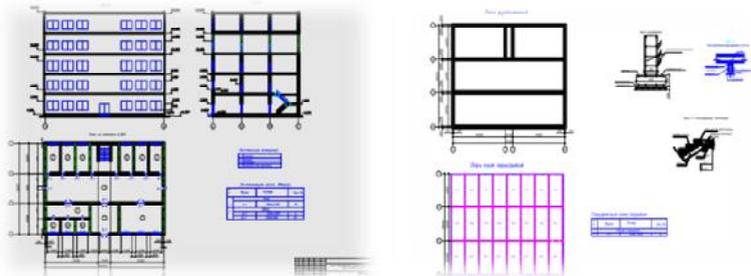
План здания на отметке 0.000: разрез, фасад, планы фундаментов и перекрытий, спецификация, экспликации и узлы
